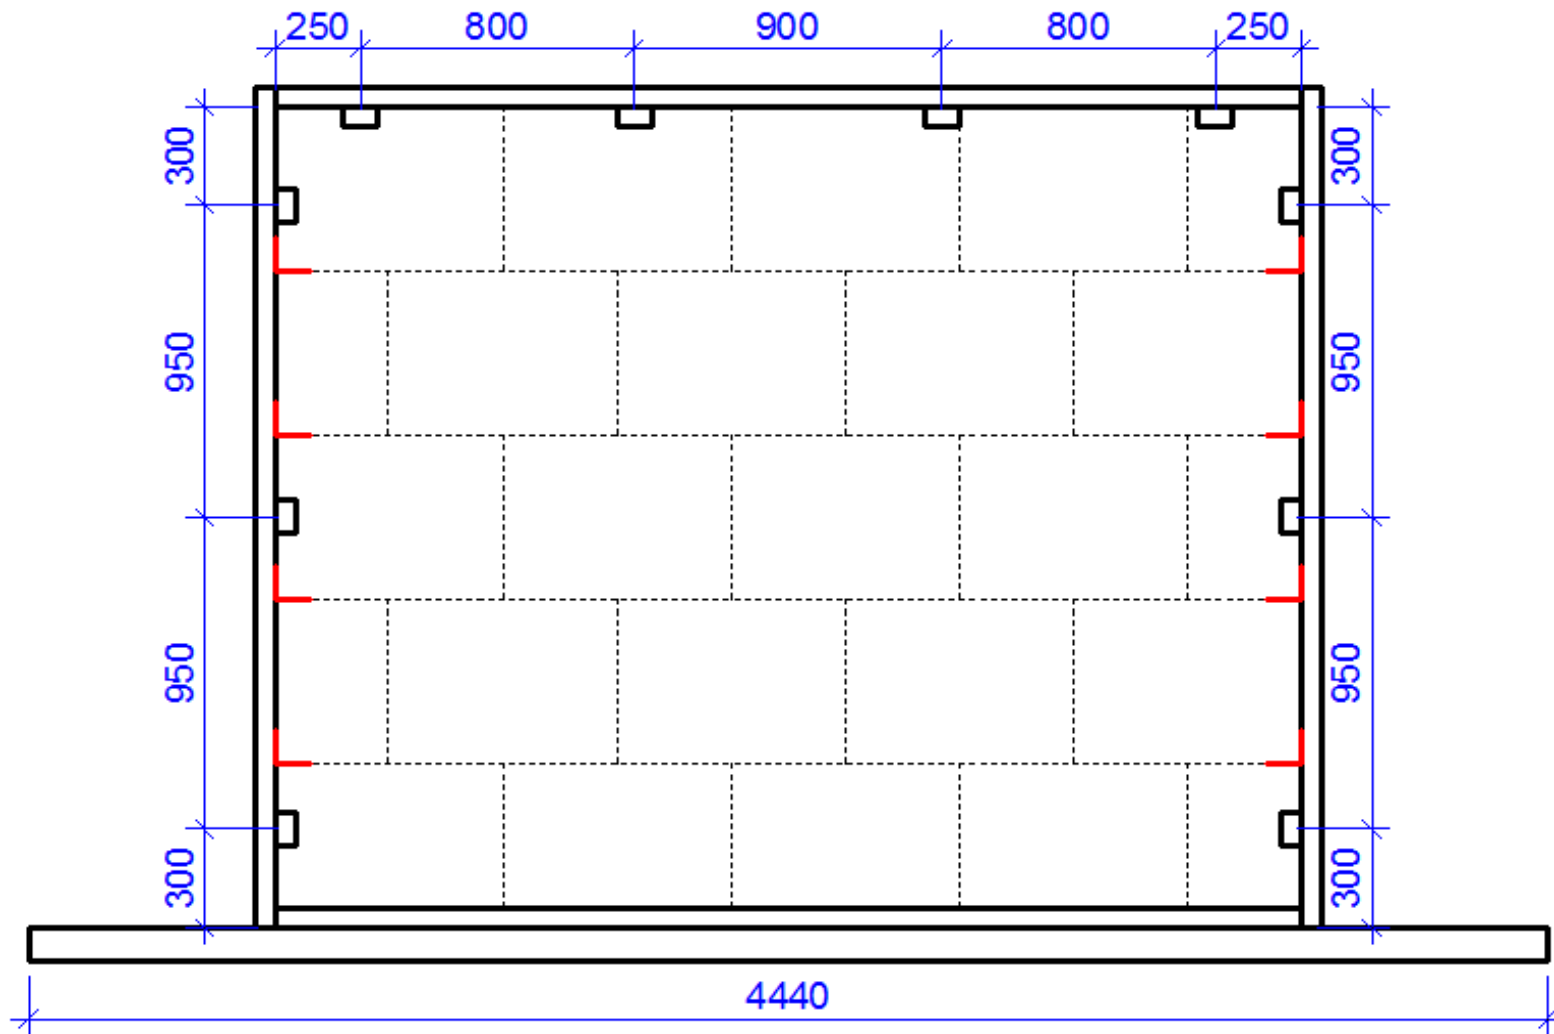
Схема расположения элементов крепления (связей) перегородки к каркасу (для сейсмоопасных регионов с балльностью площадки до 9 баллов)
